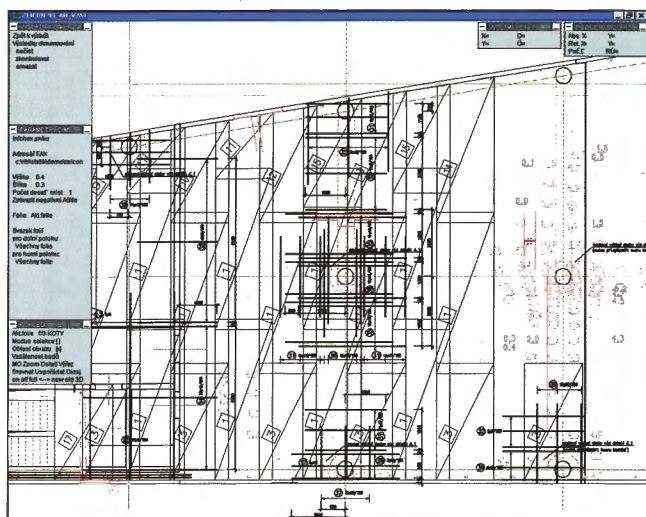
Typické podlaží a podélný řez objektu Zlatý anděl / Typical store and elevation section of Zlatý Anděl Building
